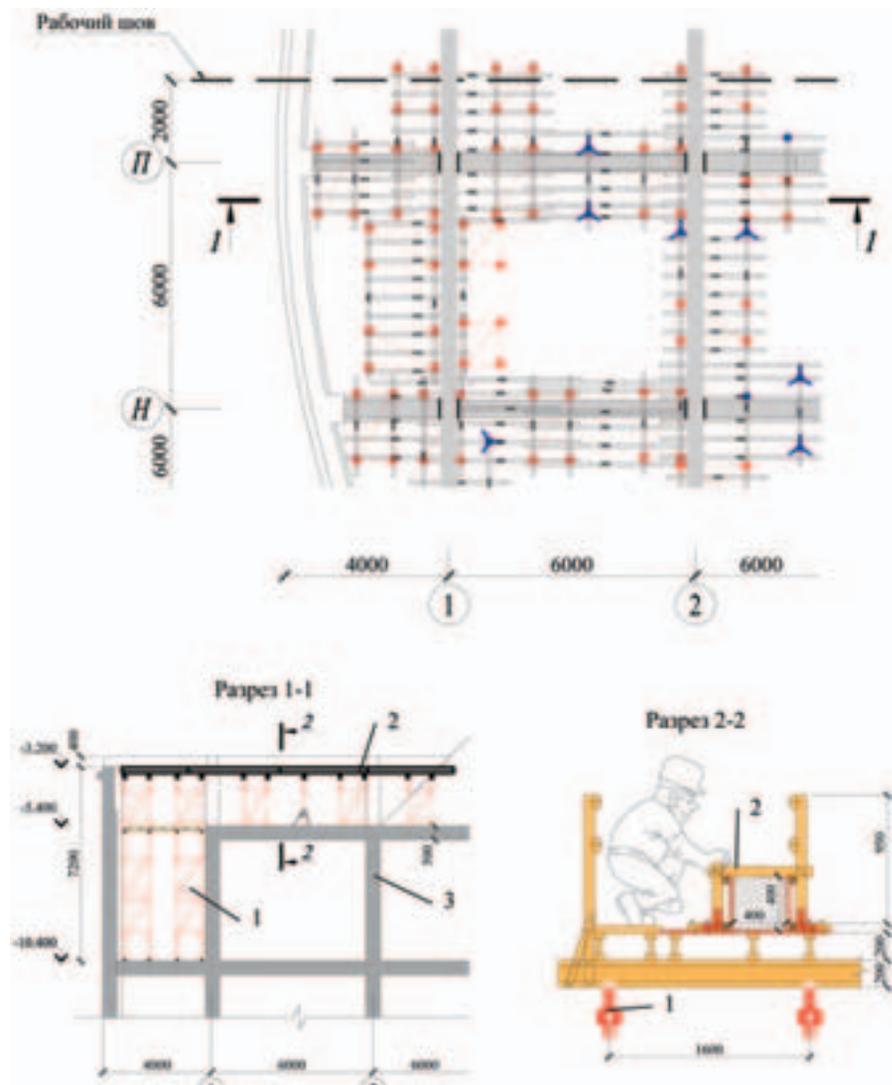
Схема опалубки перекрестных монолитных балок на отм. -3,200: 1 — опорная система из башен; 2 — опалубка монолитных балок; 3 — бетонные конструкции
